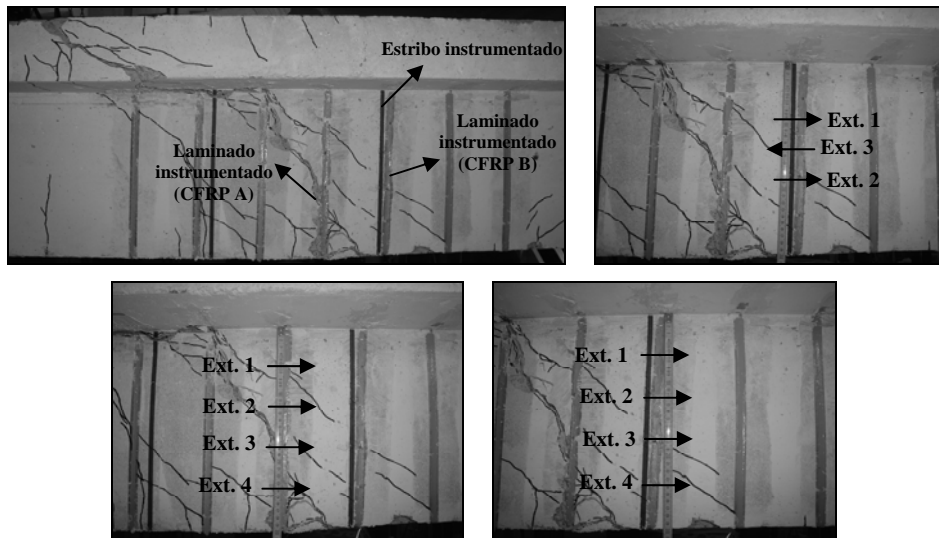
Localização dos extensómetros no laminado e estribo instrumentados da viga 2S-7LV-C.
